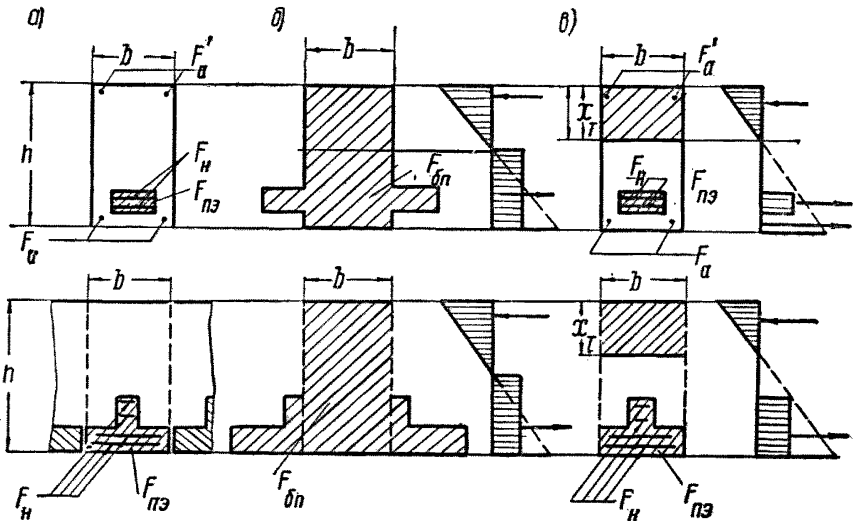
Схемы для определения приведенных сечений и эпюры напряжений при расчете трещиностойкости конструкций, армированных предварительно напряженными элементами
